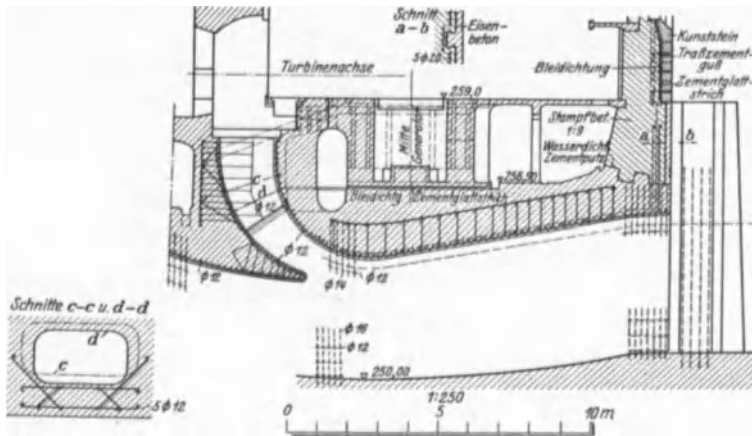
Wyhlen, Bewehrung des Betonsaugrohrs und Auslaufgerinnes. (Schweiz. Bauztg. 1913.)
